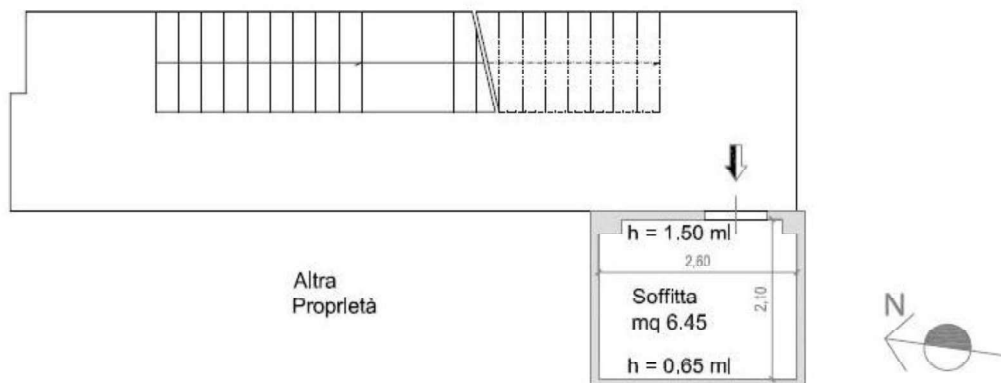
Planimetria Stato di Fatto, Piano Quinto, Foglio 22, p.la 267, Sub 20.
